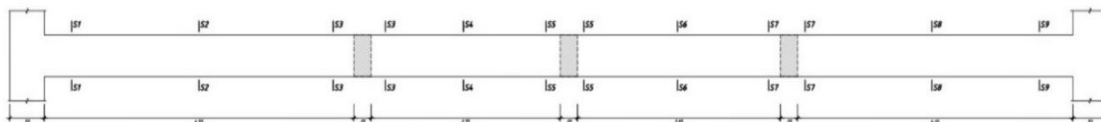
Secciones de diseño de viga de gravedad. Fuente: Propia.
